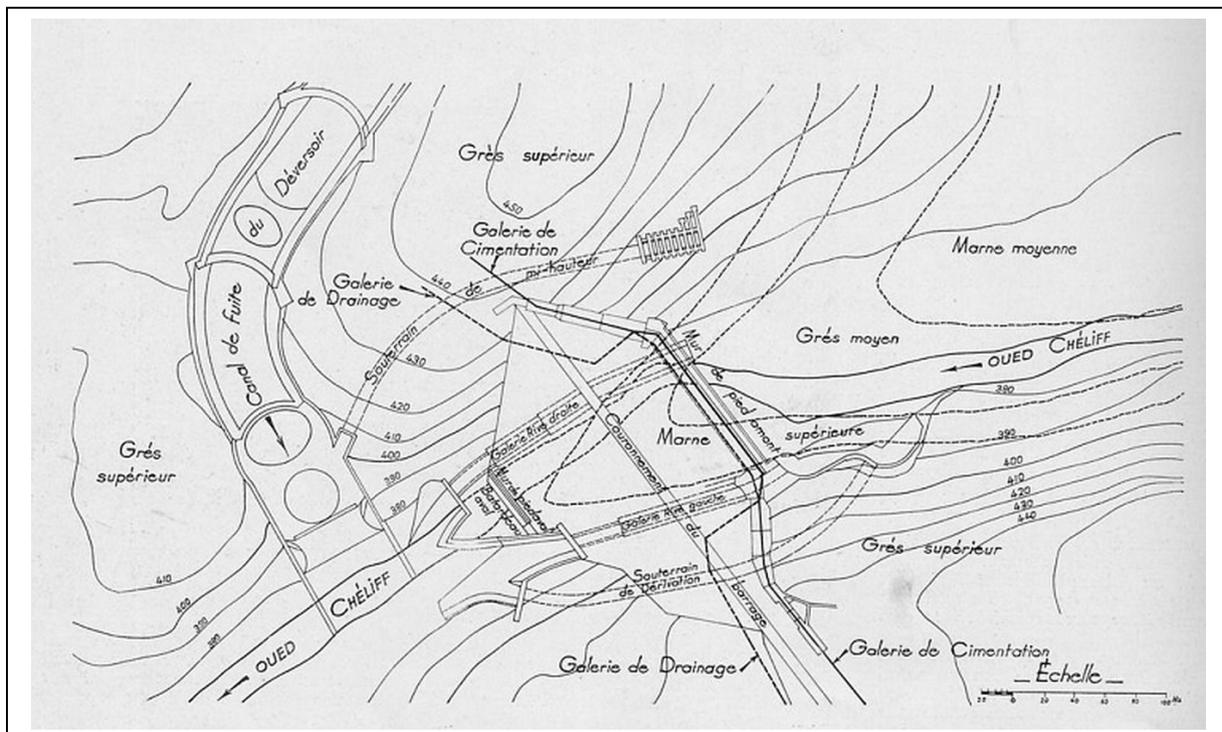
Plan Général des Ouvrages du Barrage de Ghrib [13]
